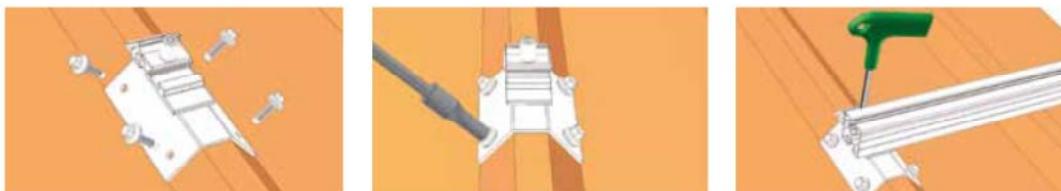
Detalle de fijación a cubierta de chapa trapezoidal.
